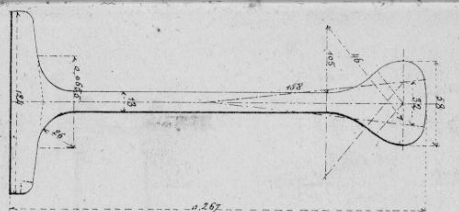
Section du Rail et de l'éclisse, constr^{te} au Profil (1/2) e
